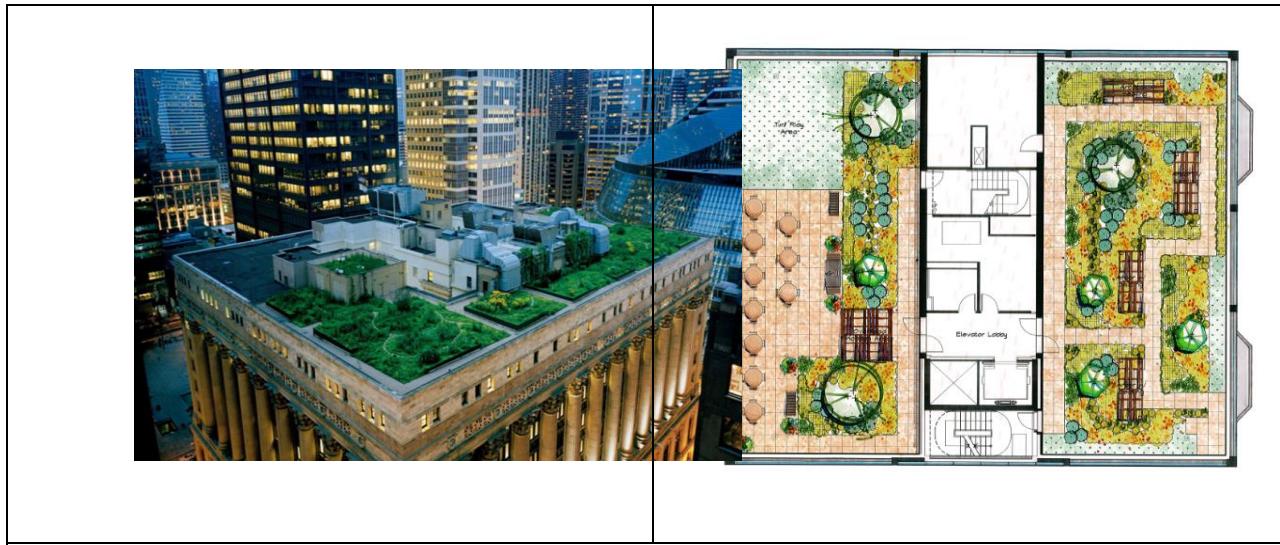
Пример размещения сада на кровле высотного здания
